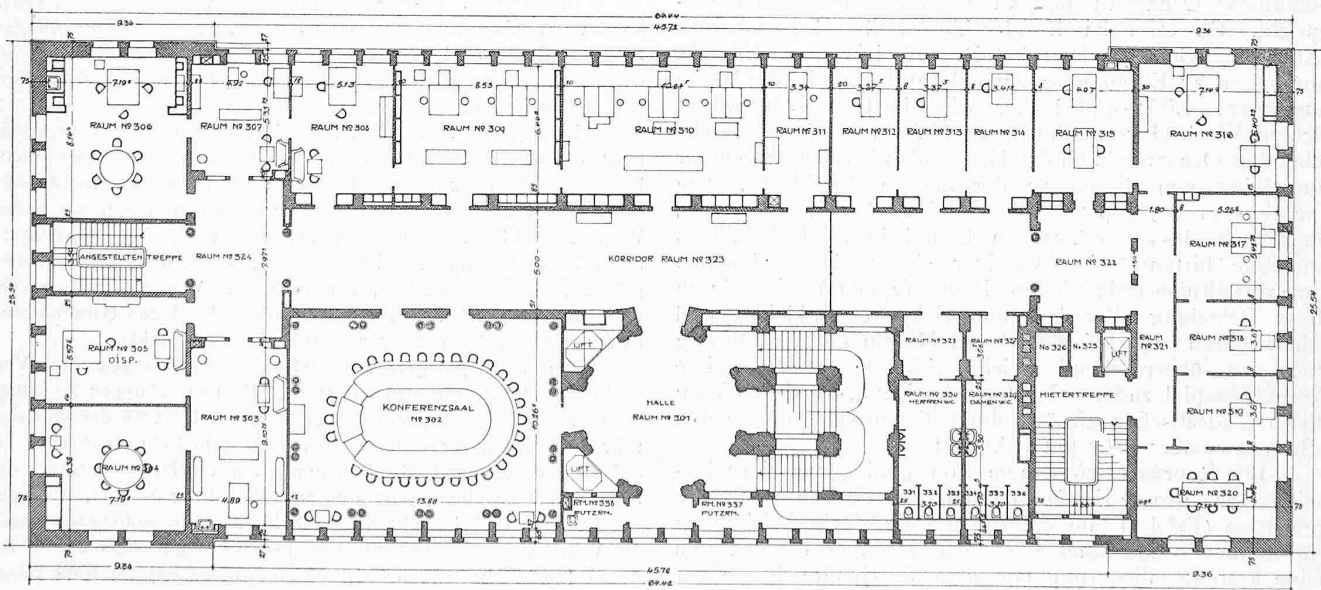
Grundriss vom III. Stock des Schweiz. Nationalbank-Gebäudes in Zürich. — Masstab 1 : 350.
